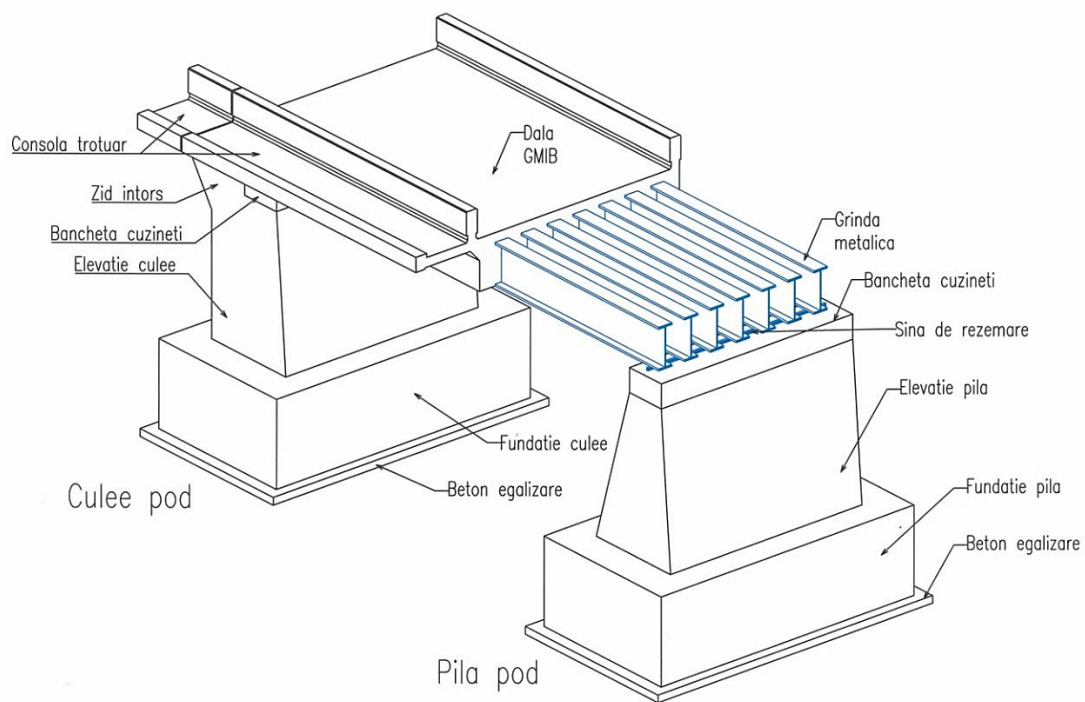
1. Elemente constructive ale unui pod structură mixtă oțel-beton tip grinzi înglobate
